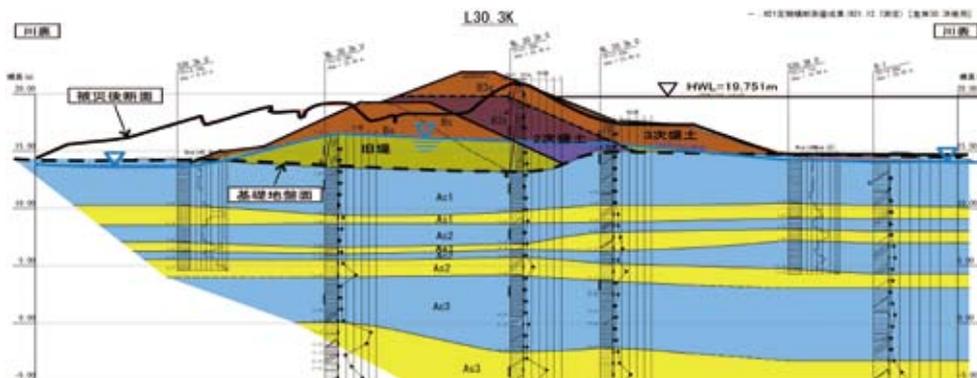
地質横断面図(鳴瀬川左岸 30.3k)
